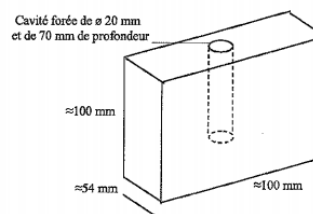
Dimensions des éprouvettes et du trou à forer
